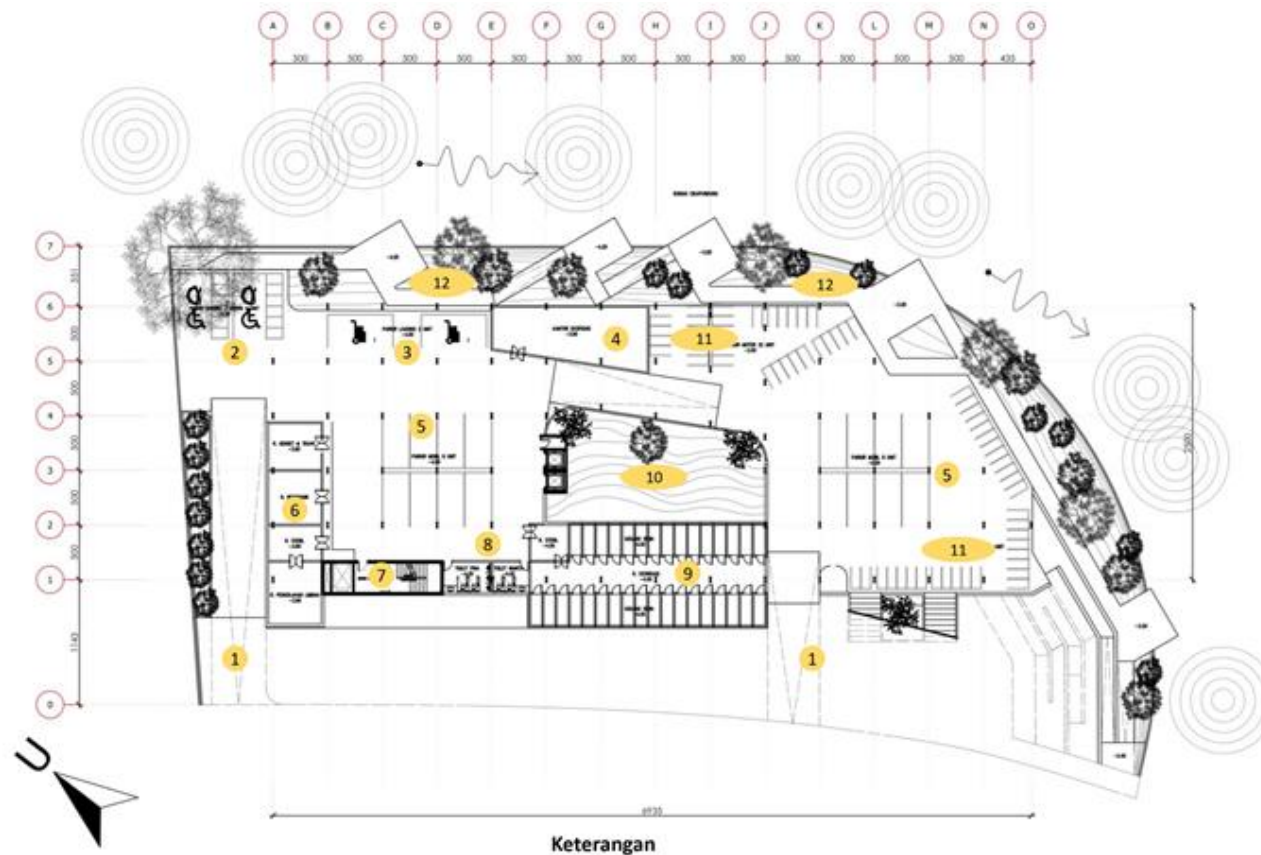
Penataan Zonasi Horizontal Lantai Semi Basement
